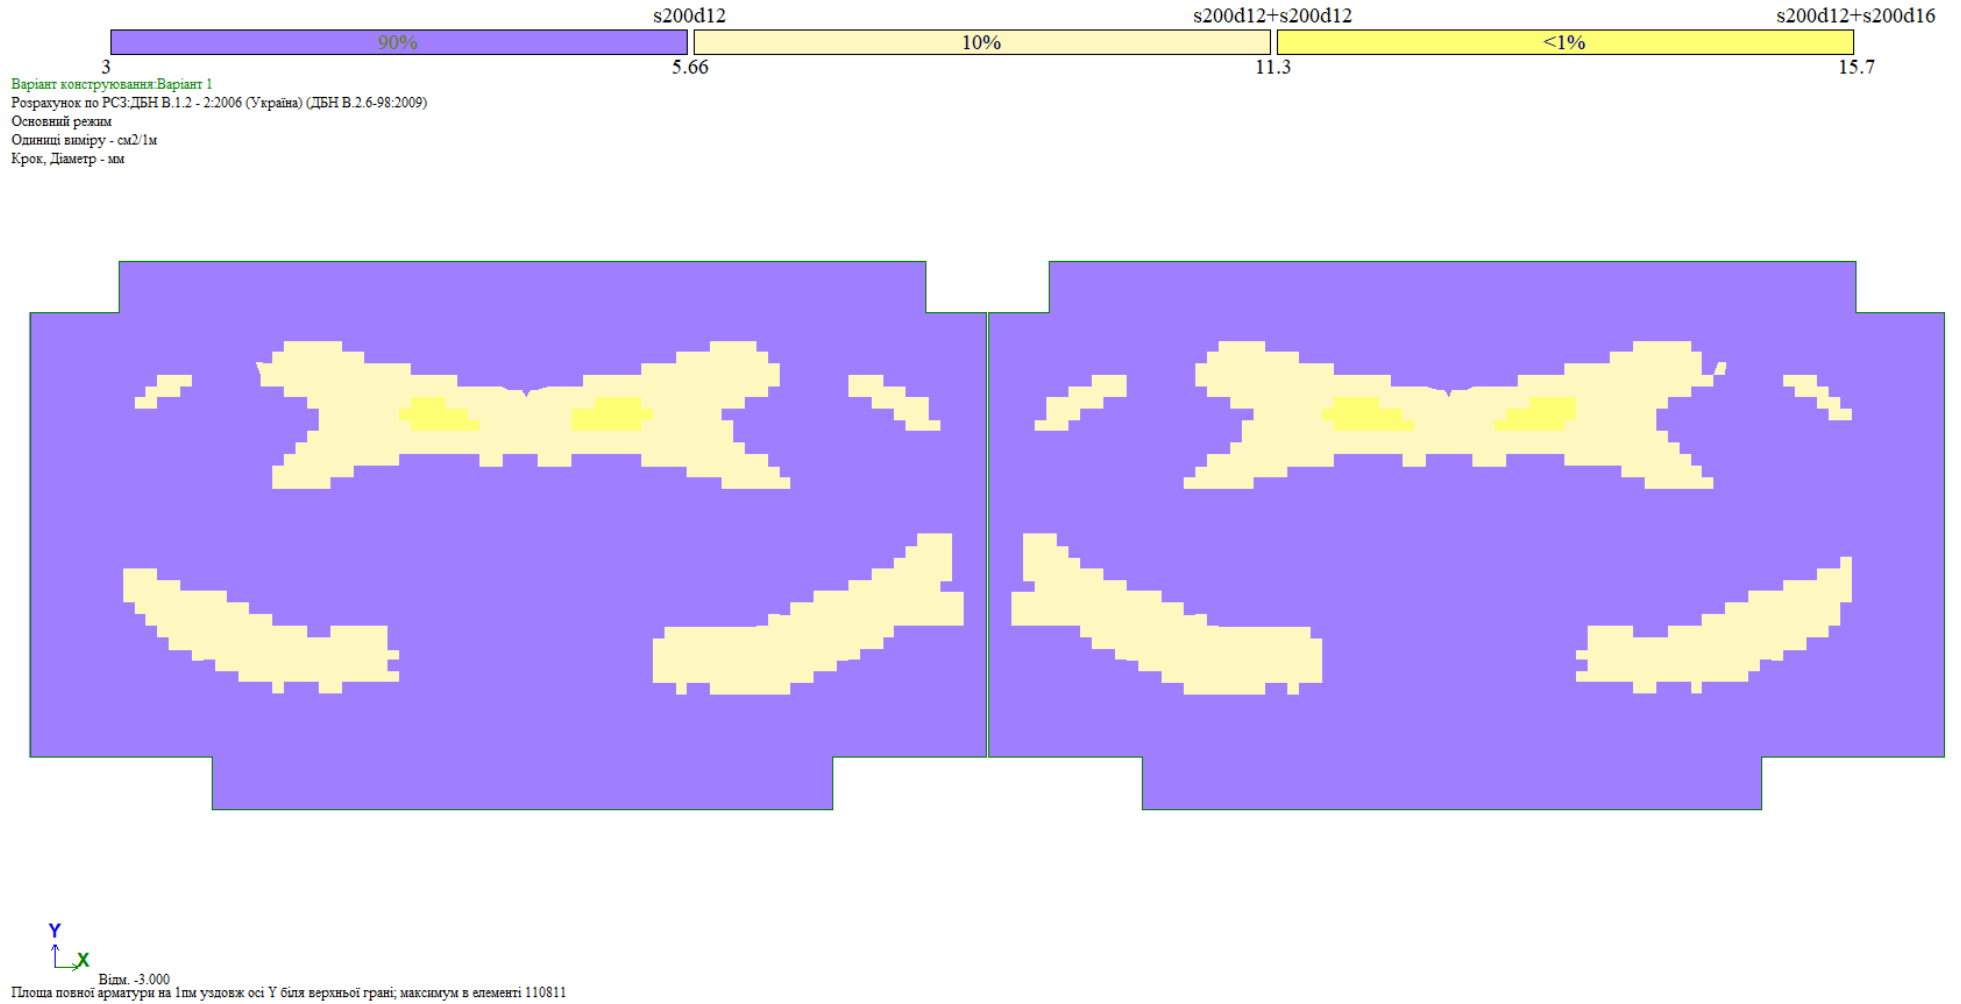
Армуння верхньої зони вздовж осі Y (см²/1м) фундаментної плити
